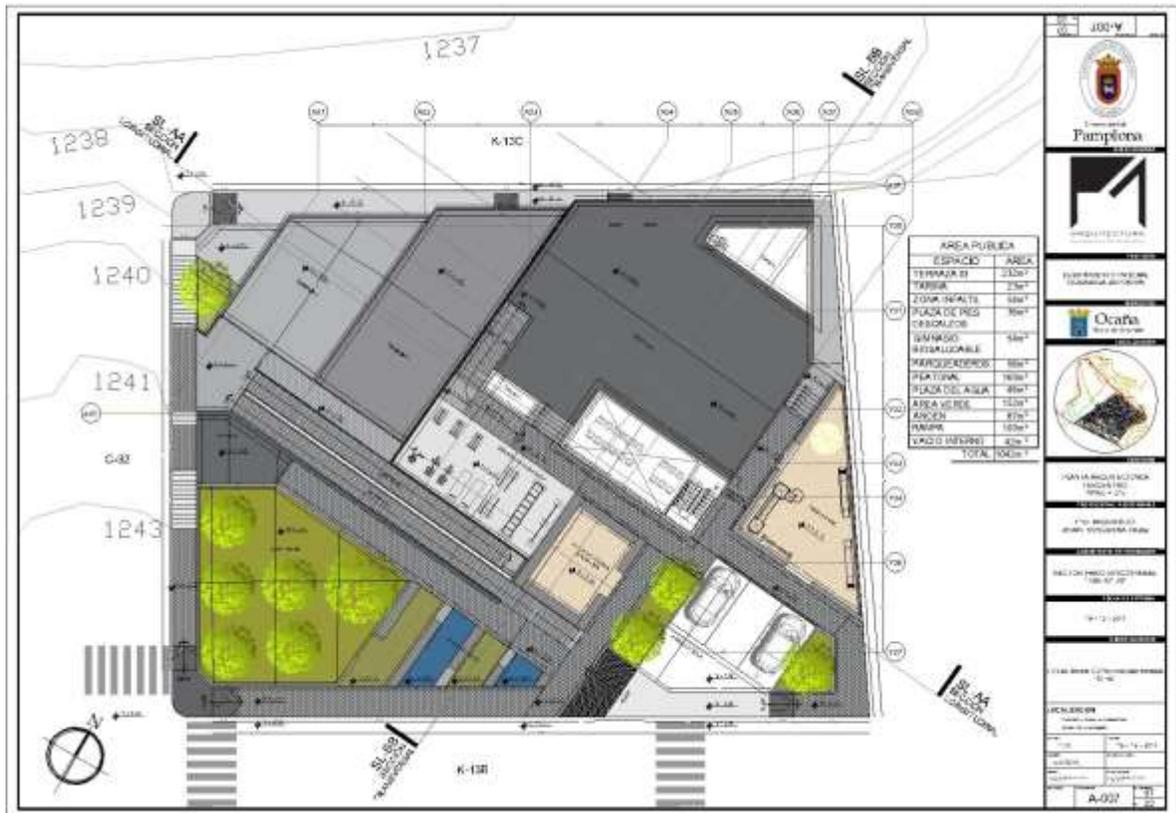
Planta Arquitectónica Nivel + 2.55.
